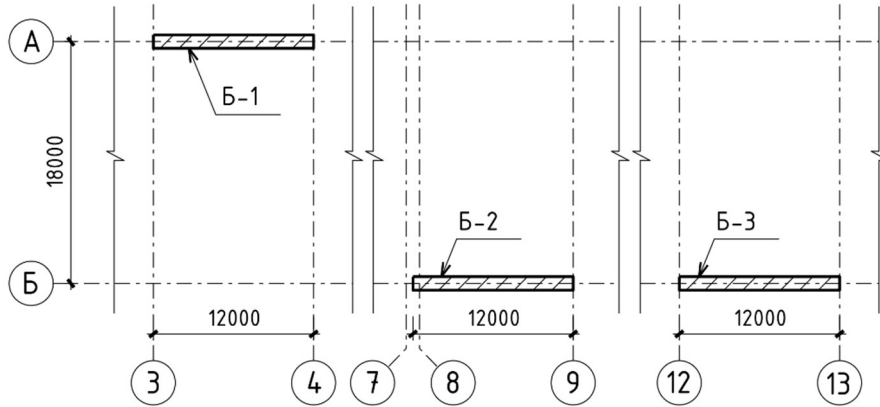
Фрагмент плану формувального цеху на відмітці 0–0 з розташуванням дефектних і пошкоджених залізобетонних балок
